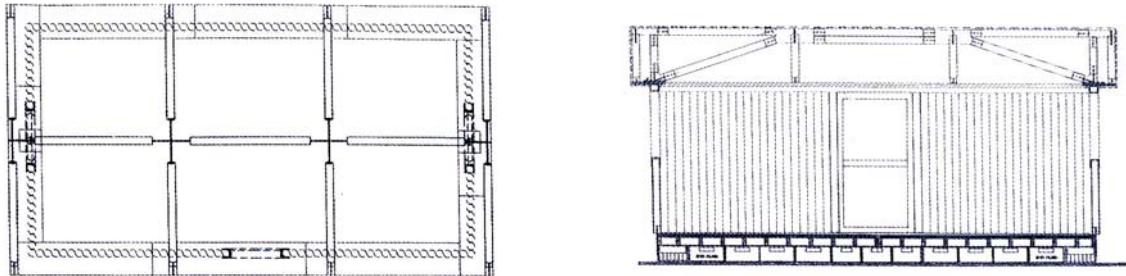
e 17 – Planta baixa e elevação longitudinal das casas construídas na Turquia. Fonte: McQuaid, 2003, p.39.
